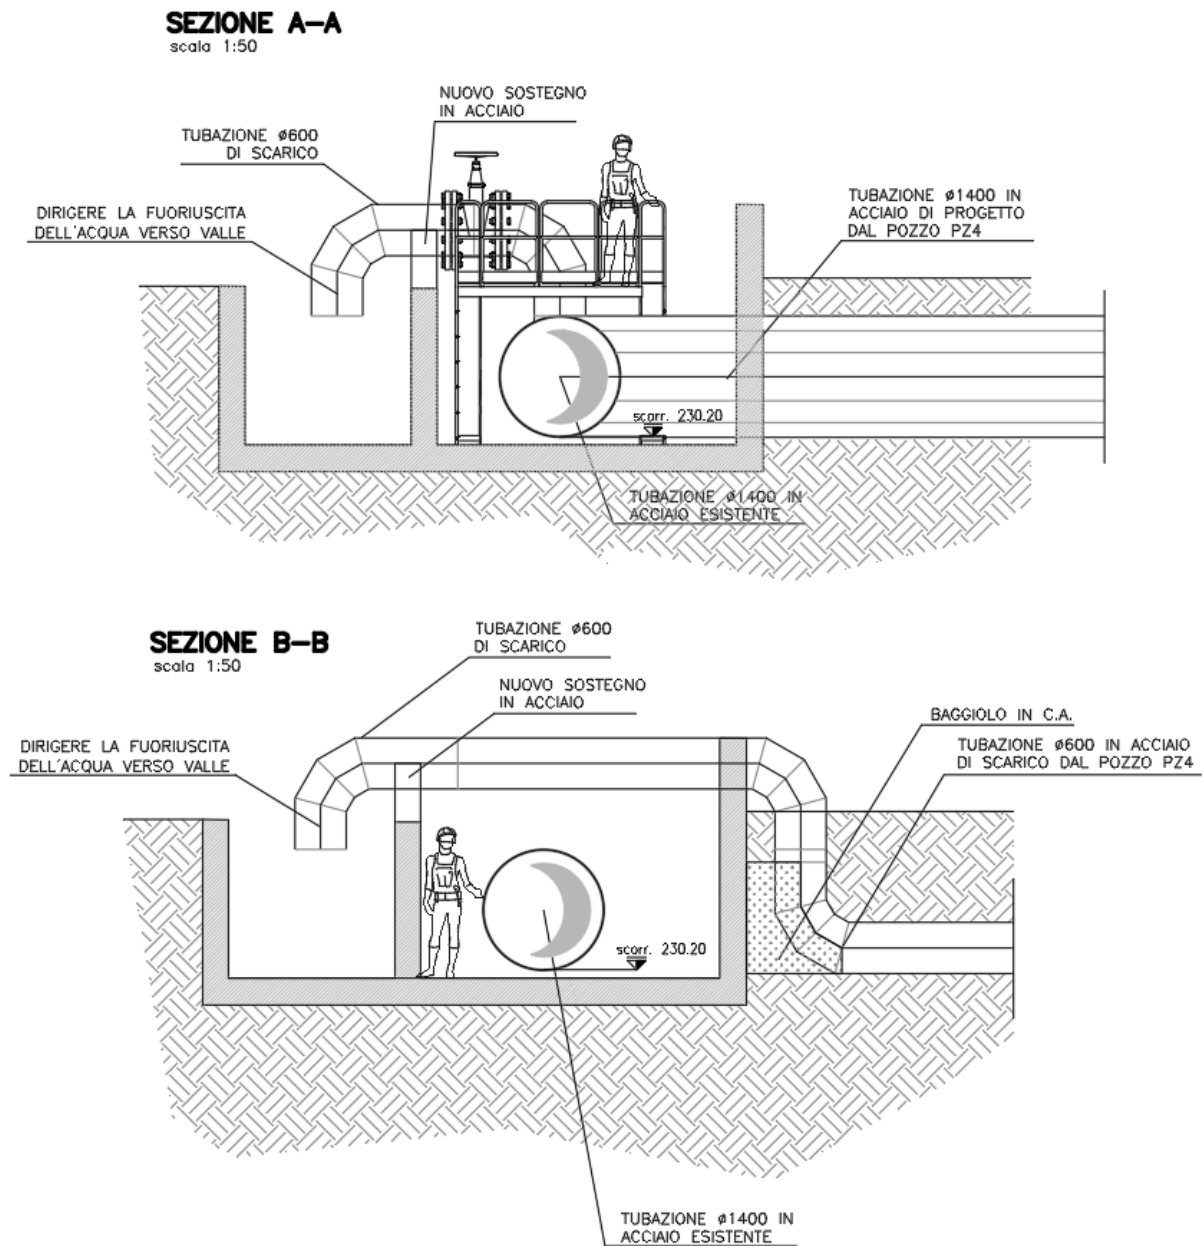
Rappresentazione in sezione del manufatto M2
